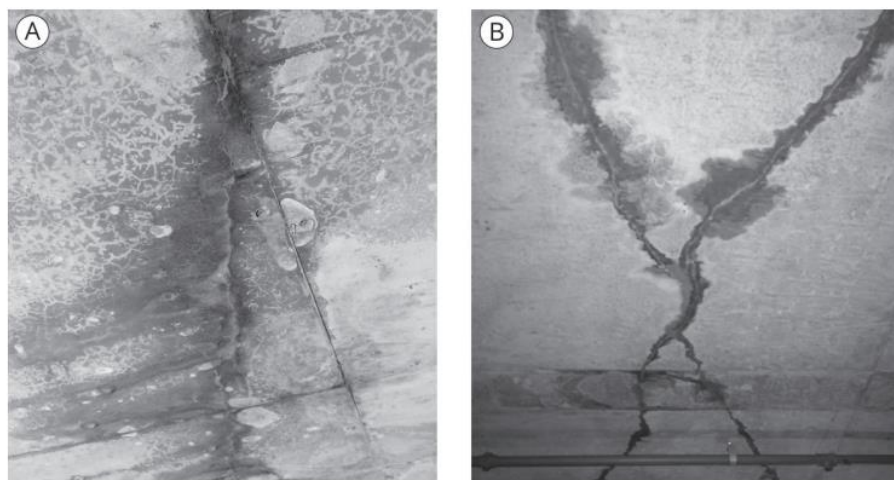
Fissuras de retração em laje com elevado consumo de cimento. (A), microfissuras mapeadas caracterizam bem a intensidade da retração. (B) Exemplo de fissura de retração.
